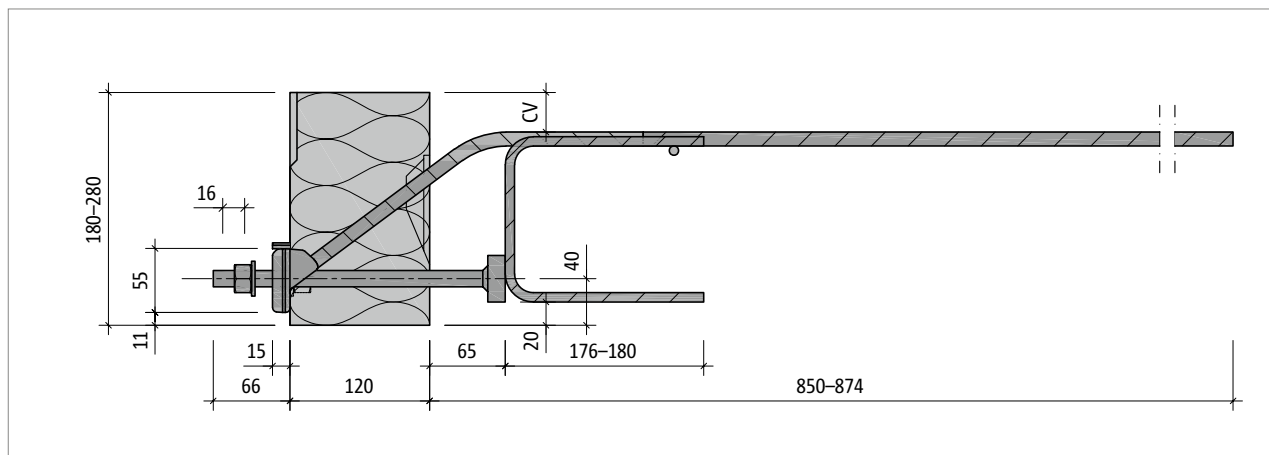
Schöck Isokorb® XT type SQ-V3 : vue en coupe du produit
